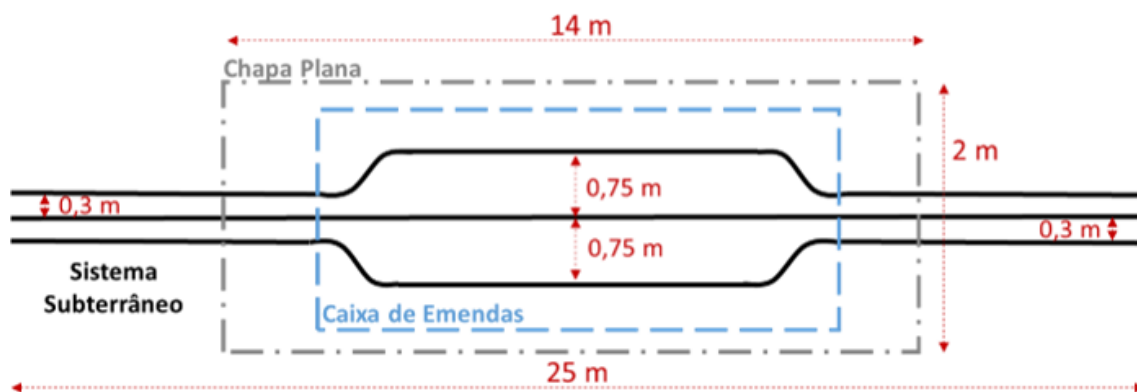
Vista superior da disposição da chapa plana de alumínio sobre o trecho da caixa de emendas do sistema subterrâneo.
